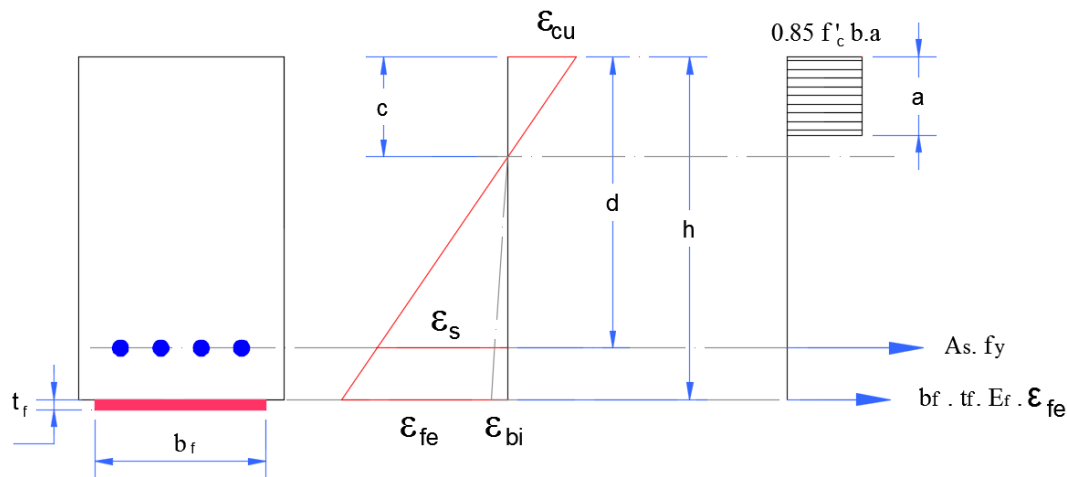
Sección de Viga de concreto armado externamente reforzada con FRP, distribución interna de deformaciones y esfuerzos bajo estado límite último.
